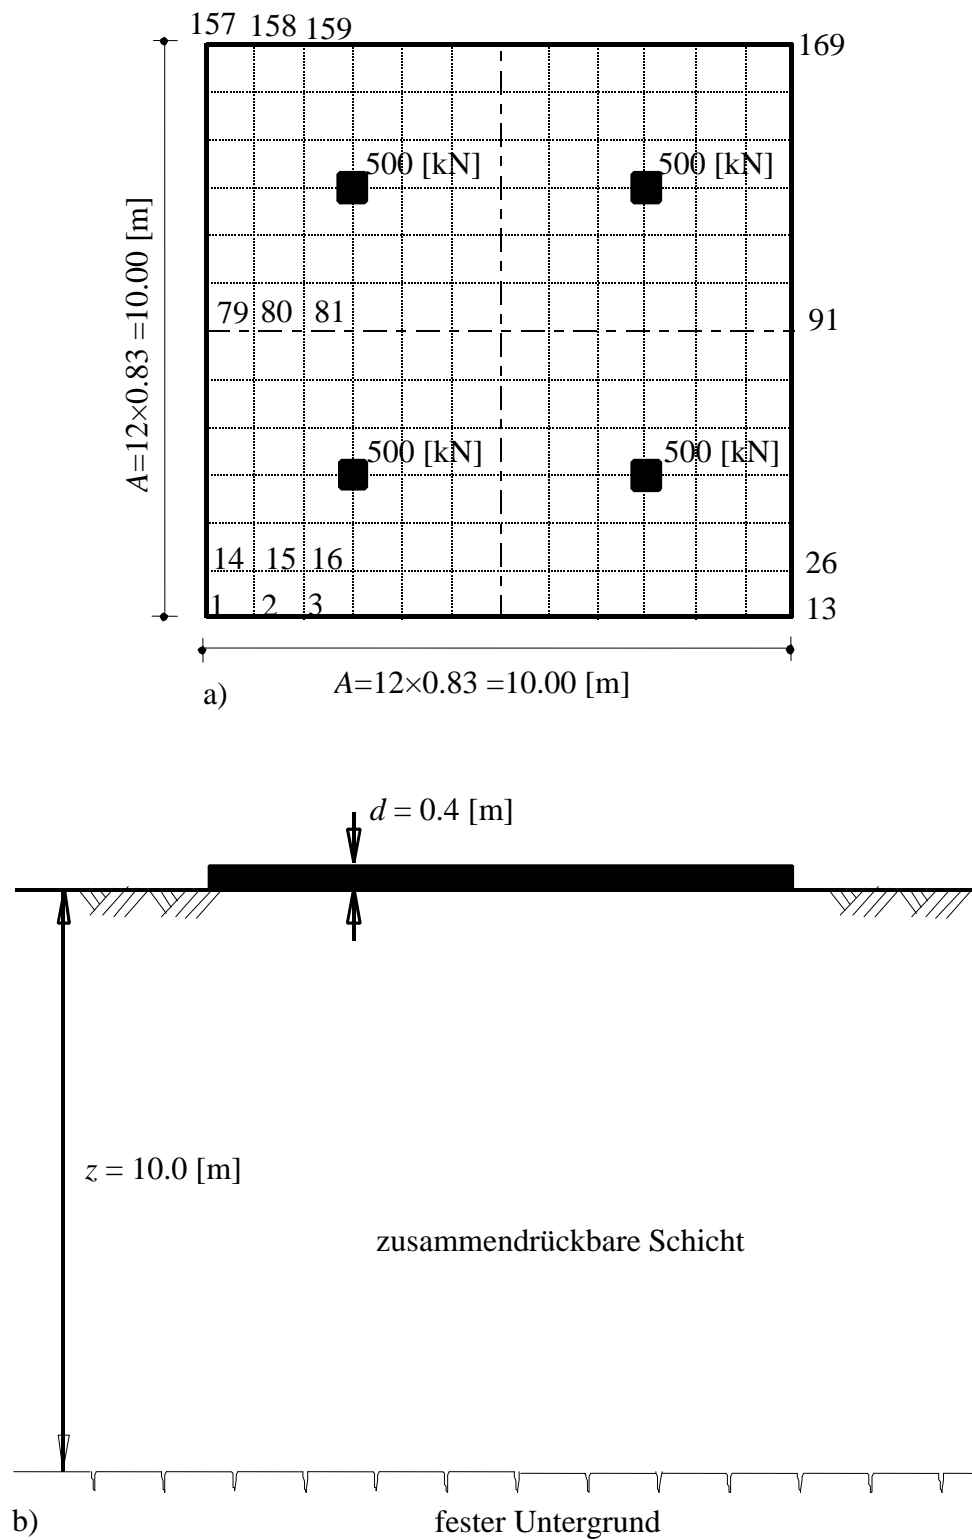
a) Nummerierung der Platte, Belastung und Grundriss
